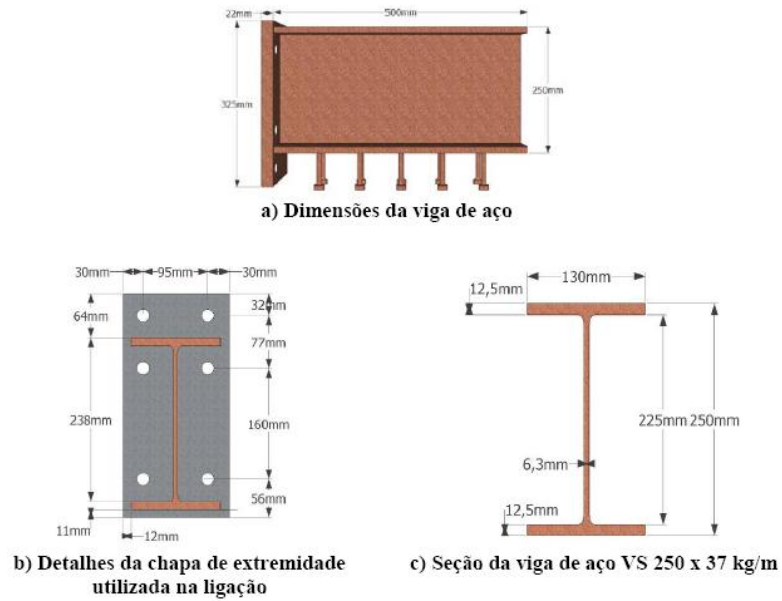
Detalhes da viga de aço. Farias (2008)
